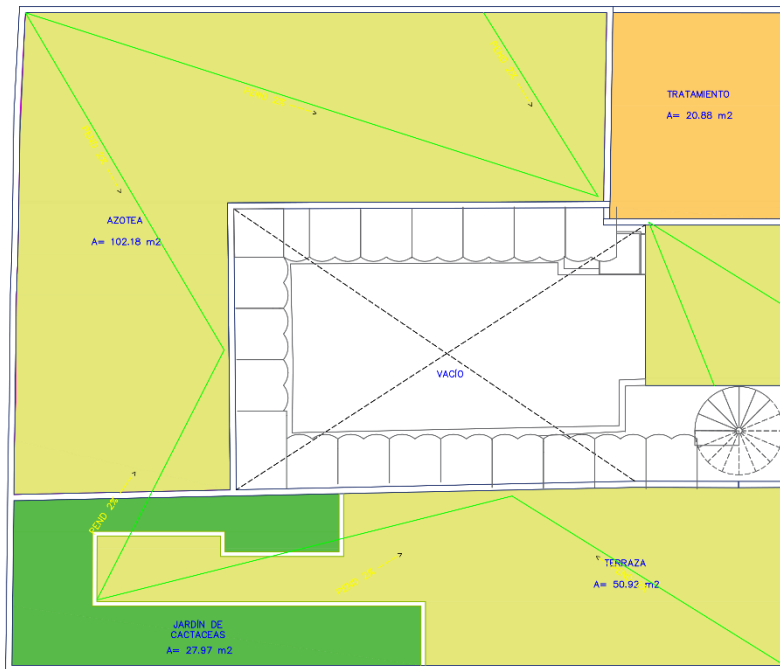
, 3.8 y 3.9 Planta de propuesta de áreas para espacios en planta baja, alta y de azotea respectivamente Fuente: Elaboración propia con el equipo de ReGenera Espacio
